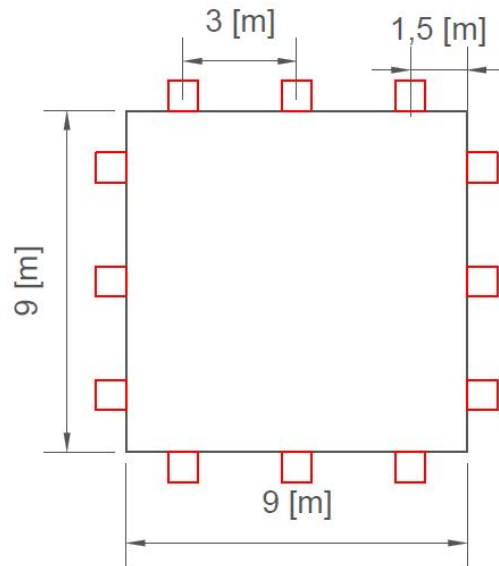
Vista en planta de excavación de área 81 [m²].
